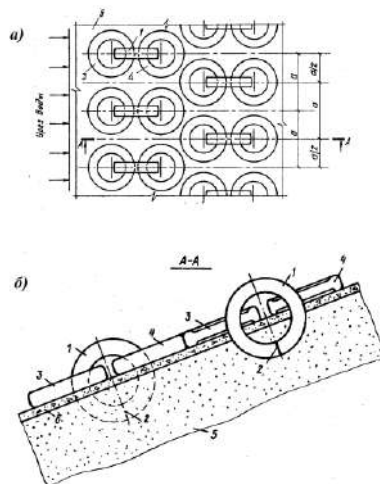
Защитное противэрозионное покрытие откоса гидротехнического сооружения (а.с. СССР № 1518 36): а – покрытие в плане; б – разрез А-А; 1 – утилизированные покрышки с предварительным поперечным разрезом; 2 – разрезы на стыке; 3 и 4 – целые утилизированные покрышки, образующие цепную связь с разрезанными покрышками; 5 – грунт откоса; 6 – железобетонная плита покрытия
